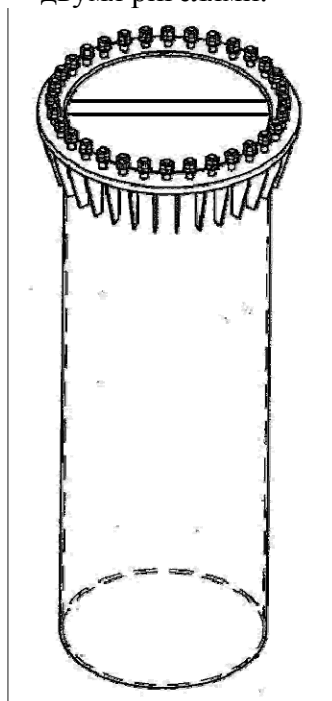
Фундамент из вибропогружаемой сваи-оболочки.
